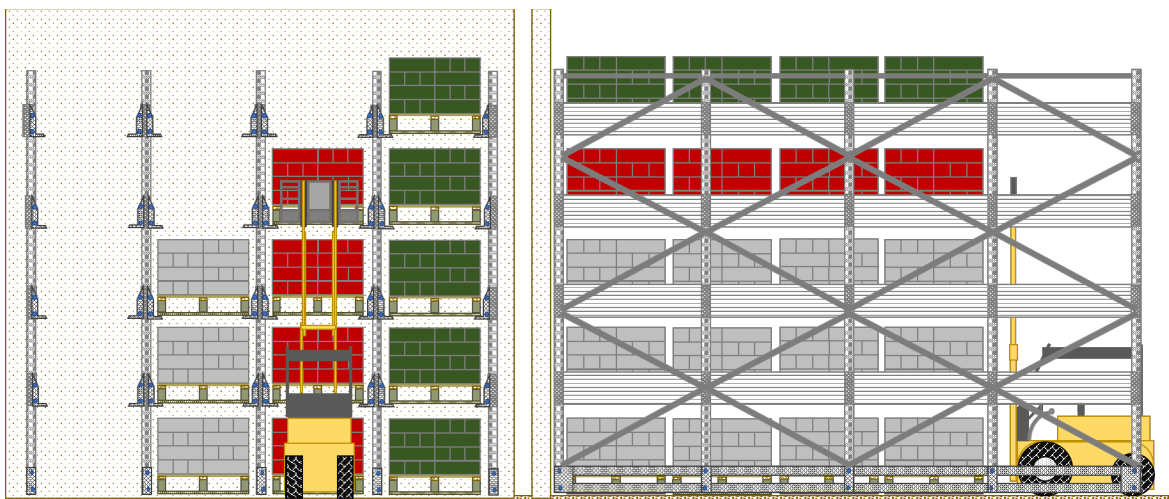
ESTANTERÍAS TIPO DRIVE IN
